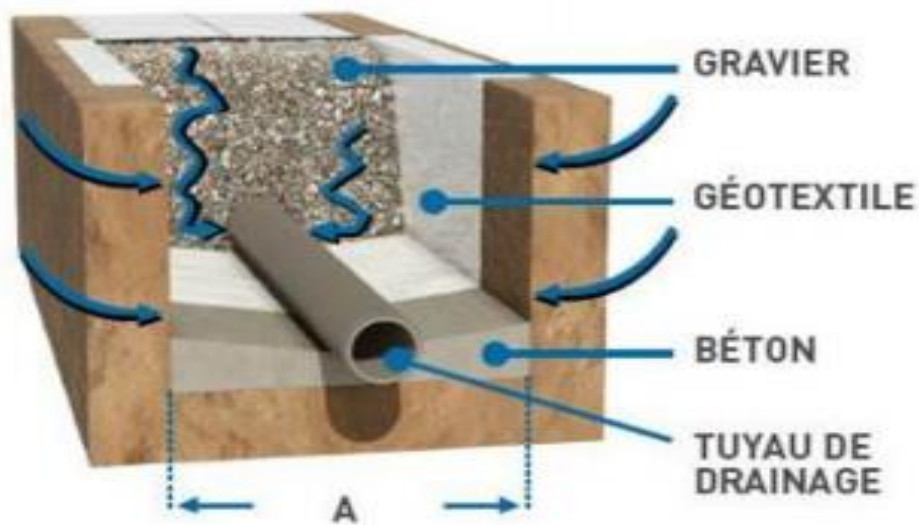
Coupe transversale d'une tranche drainante. [10]
